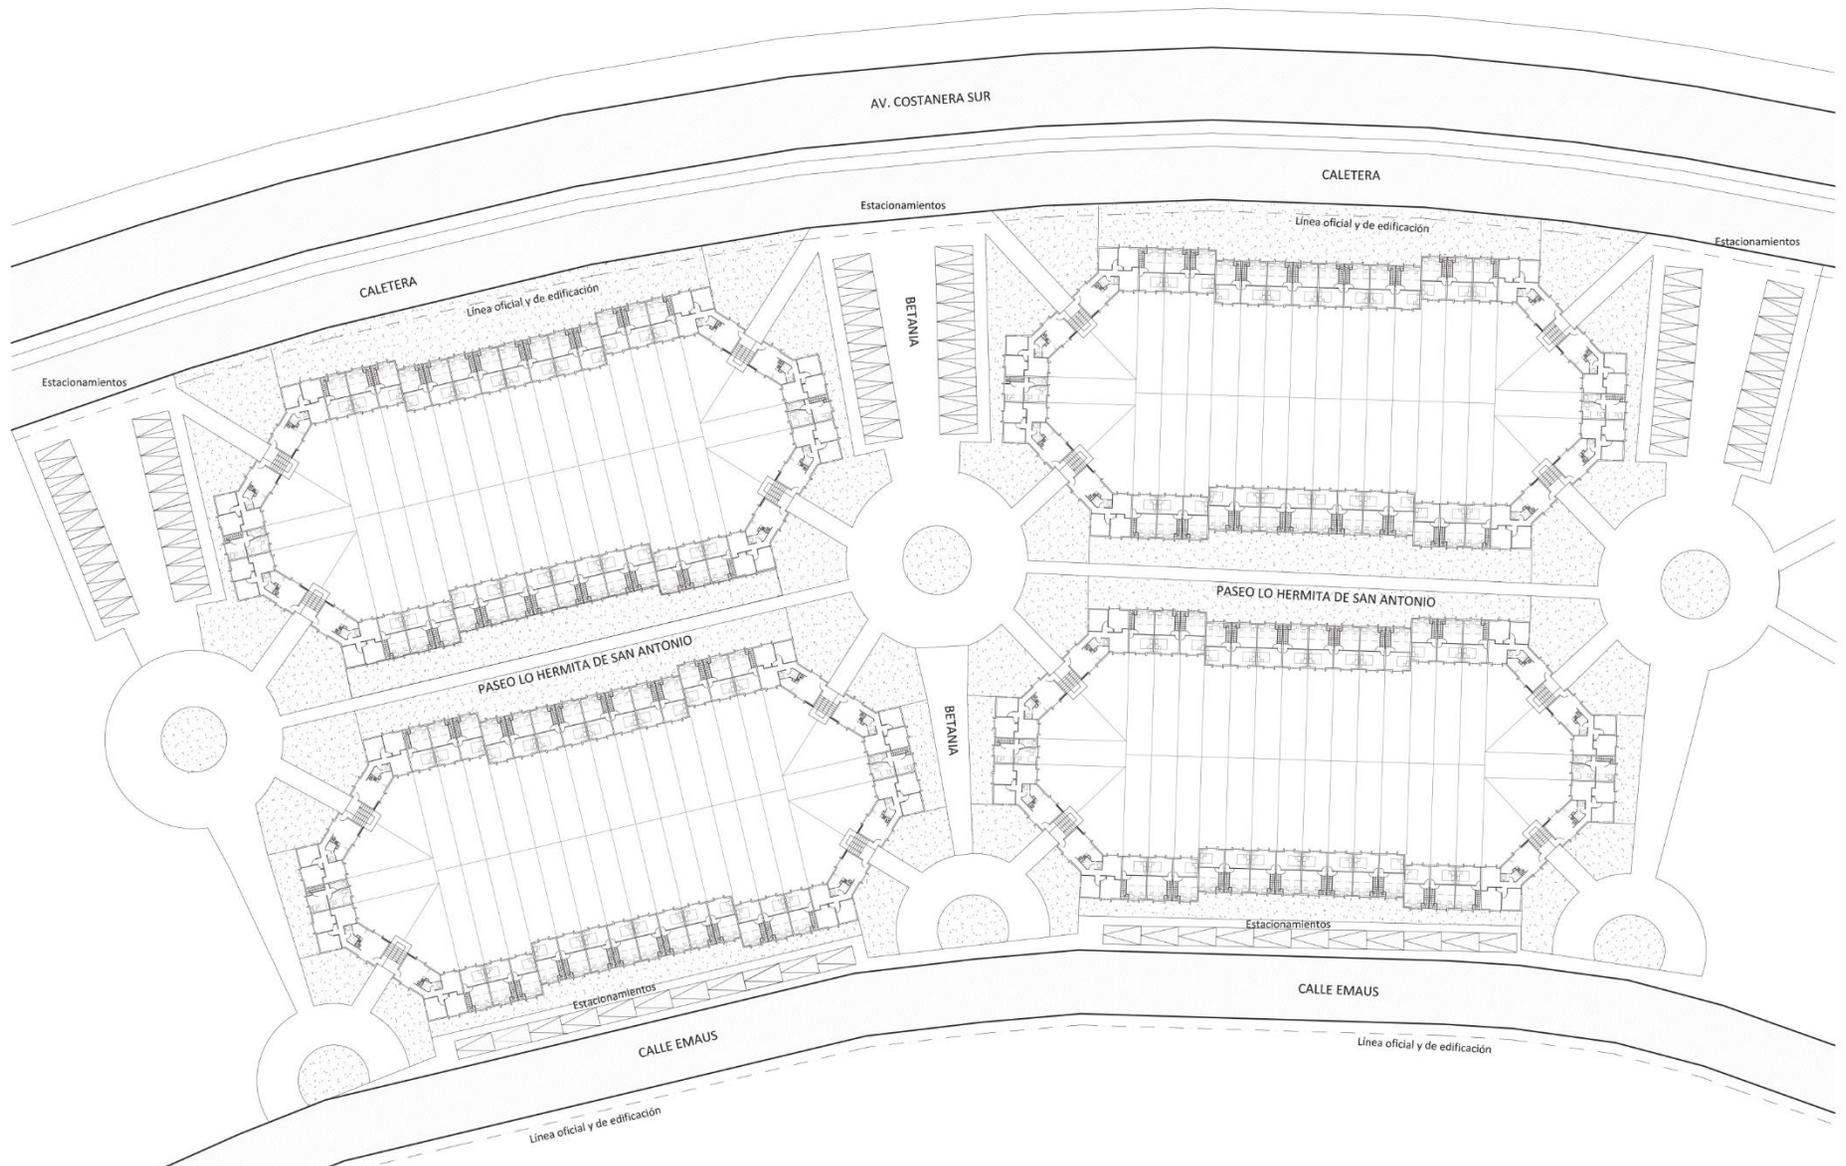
Loteo sección manzana tipo Lo Ermita, escala 1:1000. Fuente: Elaboración propia.
